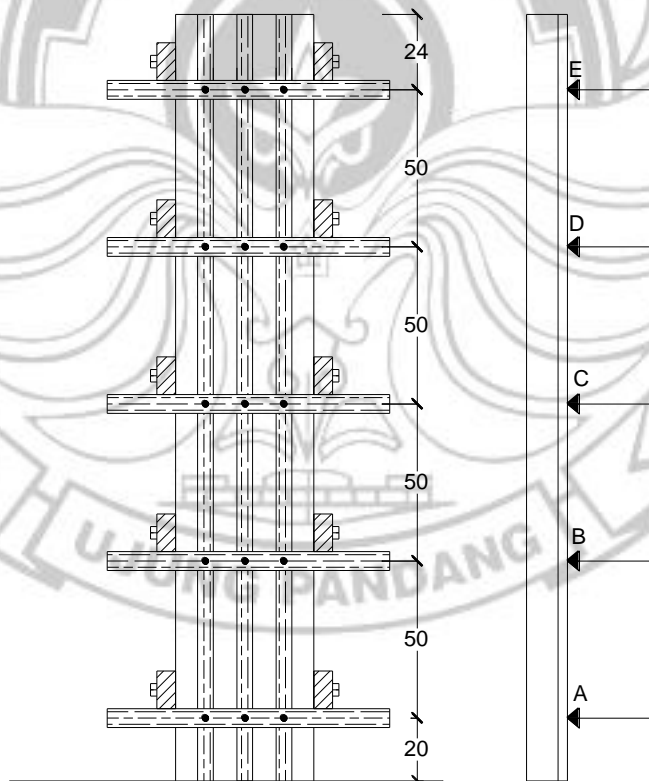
Pemodelan statik pada bekisting balok tipe tiang perancah
